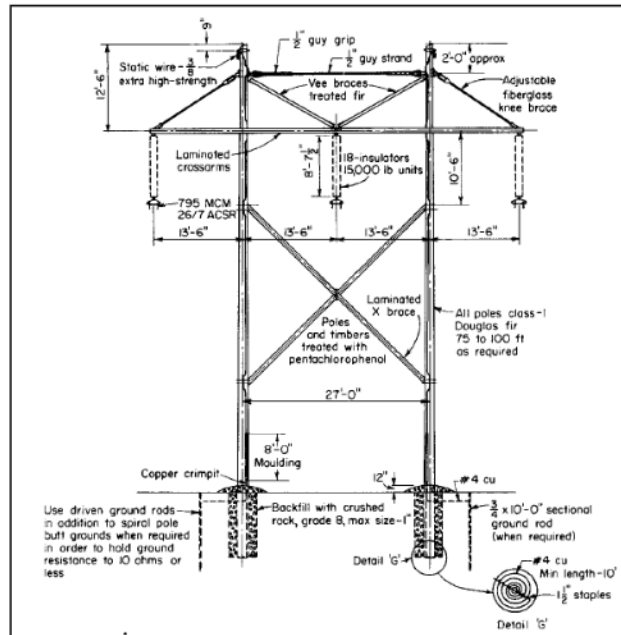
ESTRUCTURA DE MADERA TIPO H
